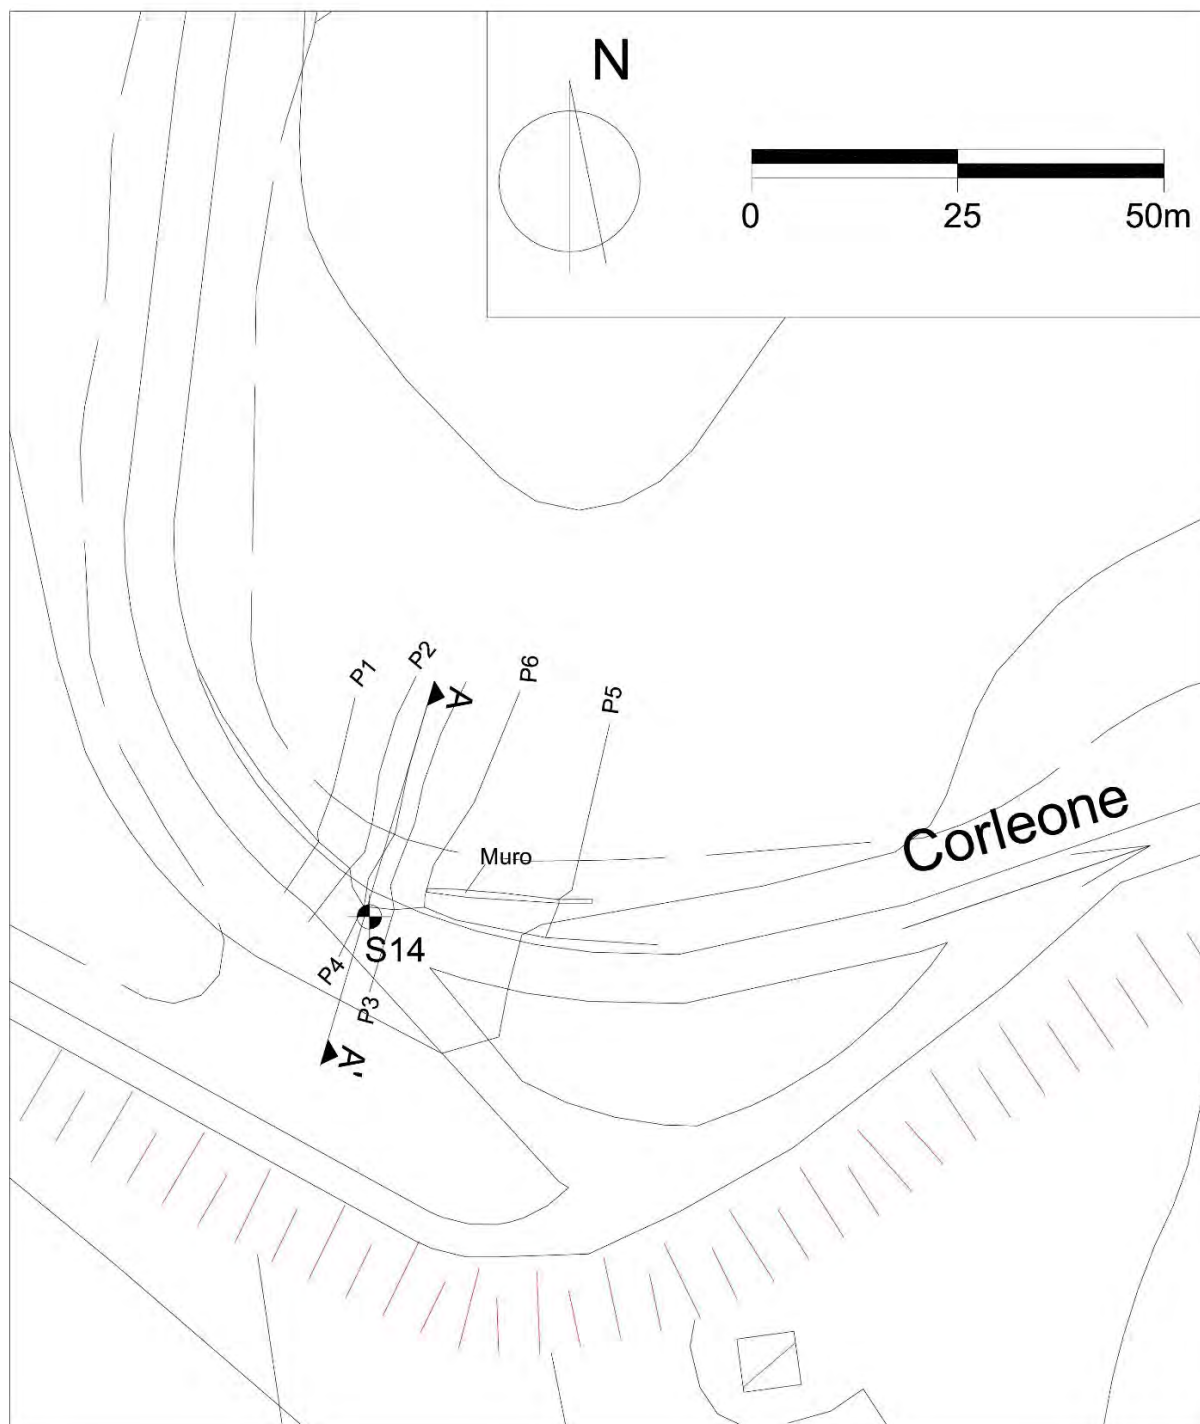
Planimetria con indicazione della zona oggetto di interesse al km 8+700 (zona Pietralunga).
